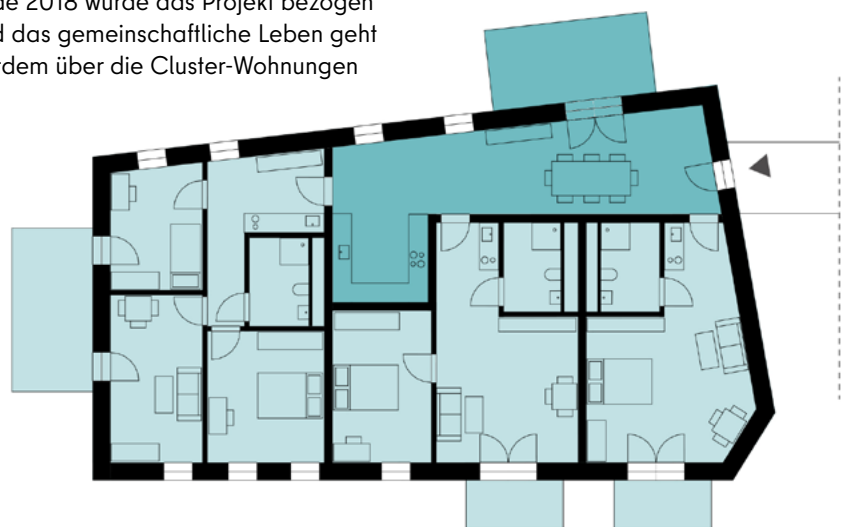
| Ein Grundriss einer Cluster-Wohnung im Projekt Gemeinschaftswohnen im Wedding
